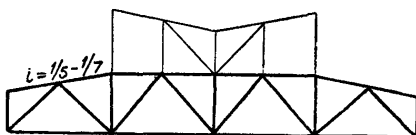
Схема стропильной фермы с горизонтальным верхним поясом на участке под фонарем
